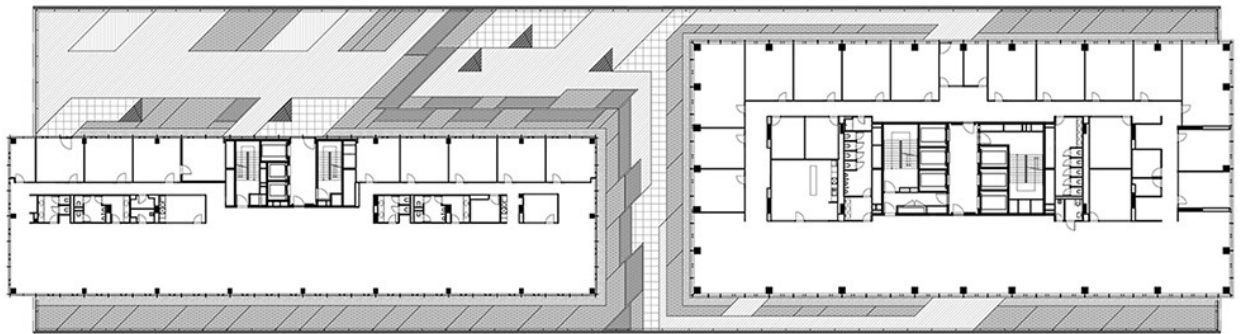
Планування типового поверху Бізнес-центру EINSTEINOVA
